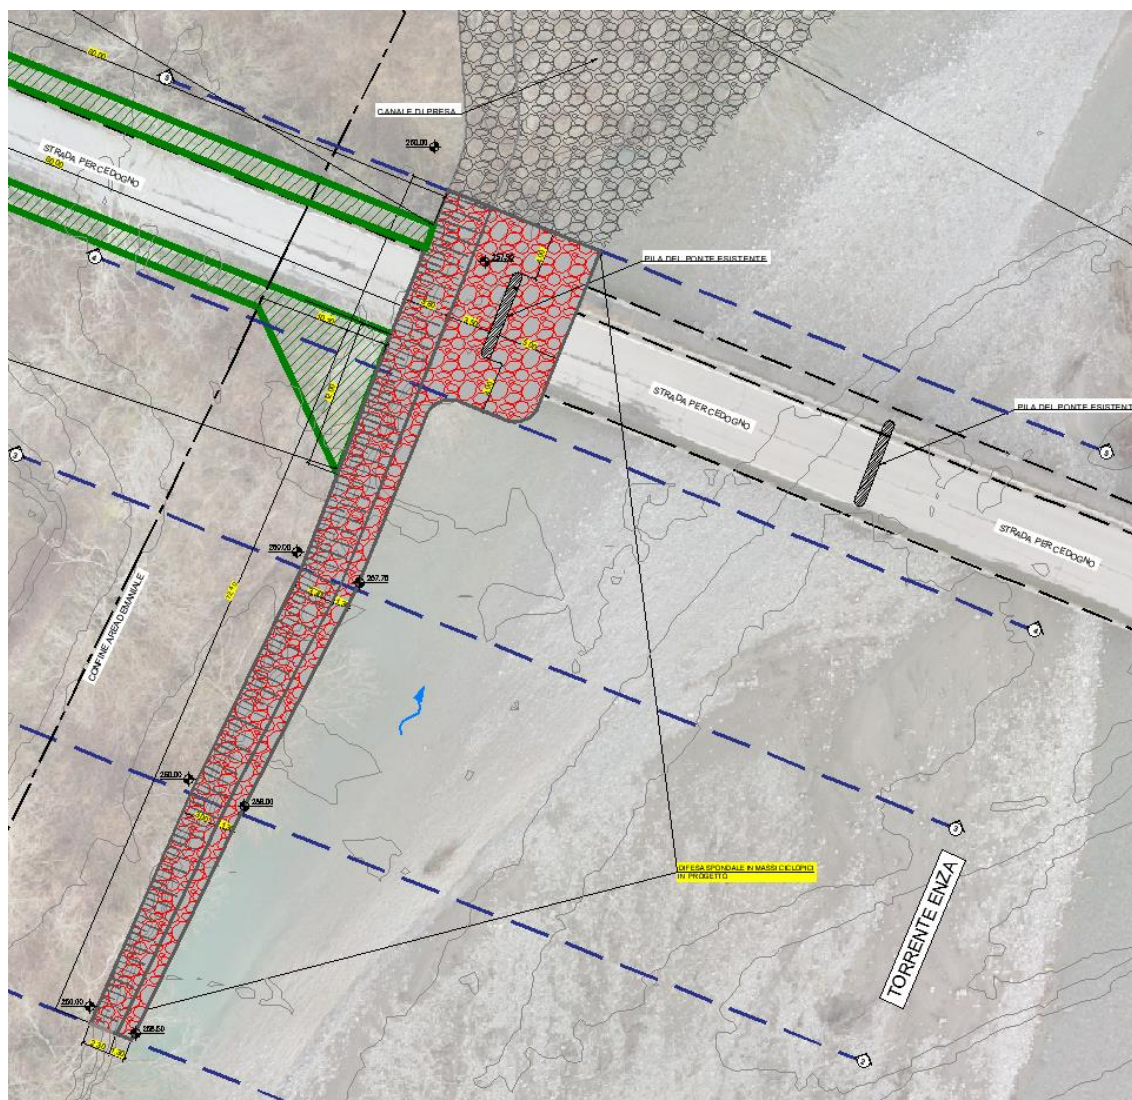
Stralcio planimetrico delle difese spondali da realizzare a monte della briglia
